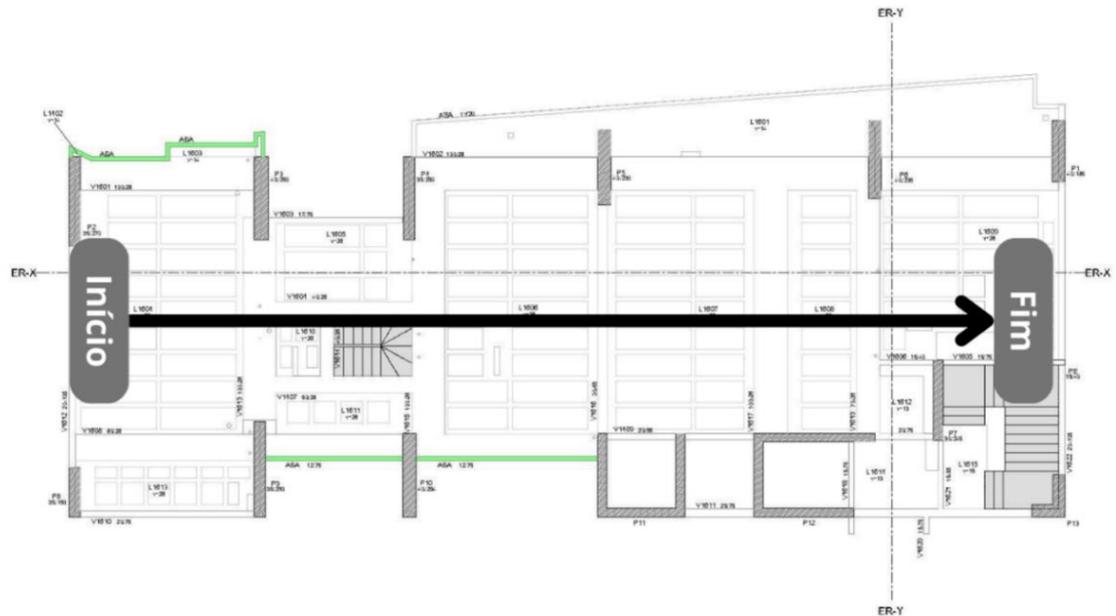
Armação das Lajes - Fonte: Autoria Própria
